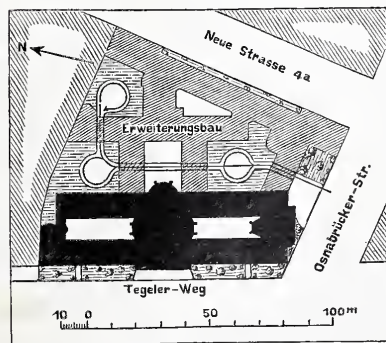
Lageplan. Landgericht III in Charlottenburg.
